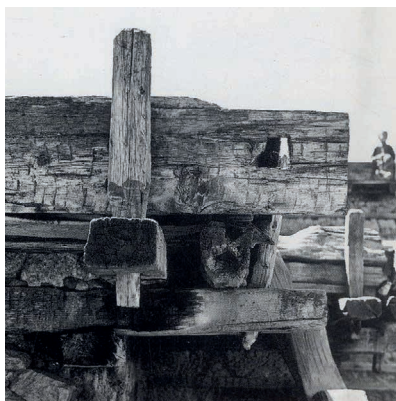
Detalle constructivo: la madera en la tradición de Taos, Nuevo México. Autor: S. Hallet.
